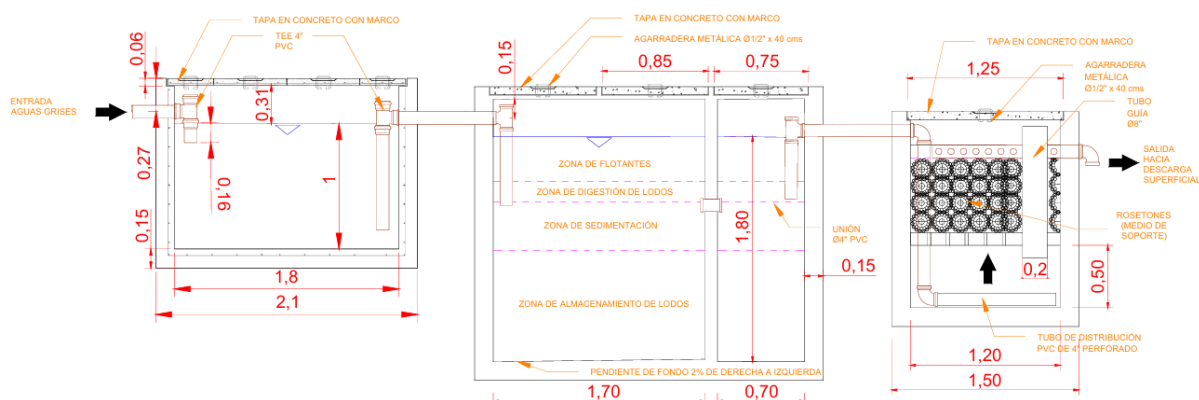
Perfil del Sistema de Saneamiento. Escala 1:100.
